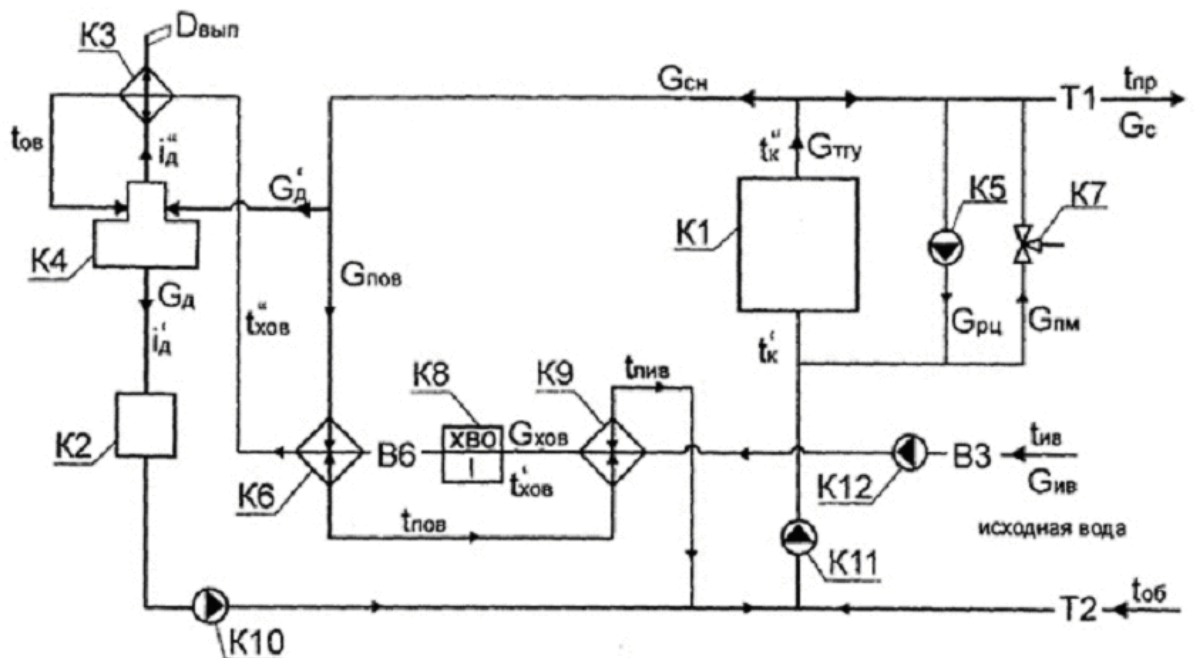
Принципиальная тепловая схема отопительной теплогенерирующей установки с водогрейными котлами и закрытой системой теплоснабжения
